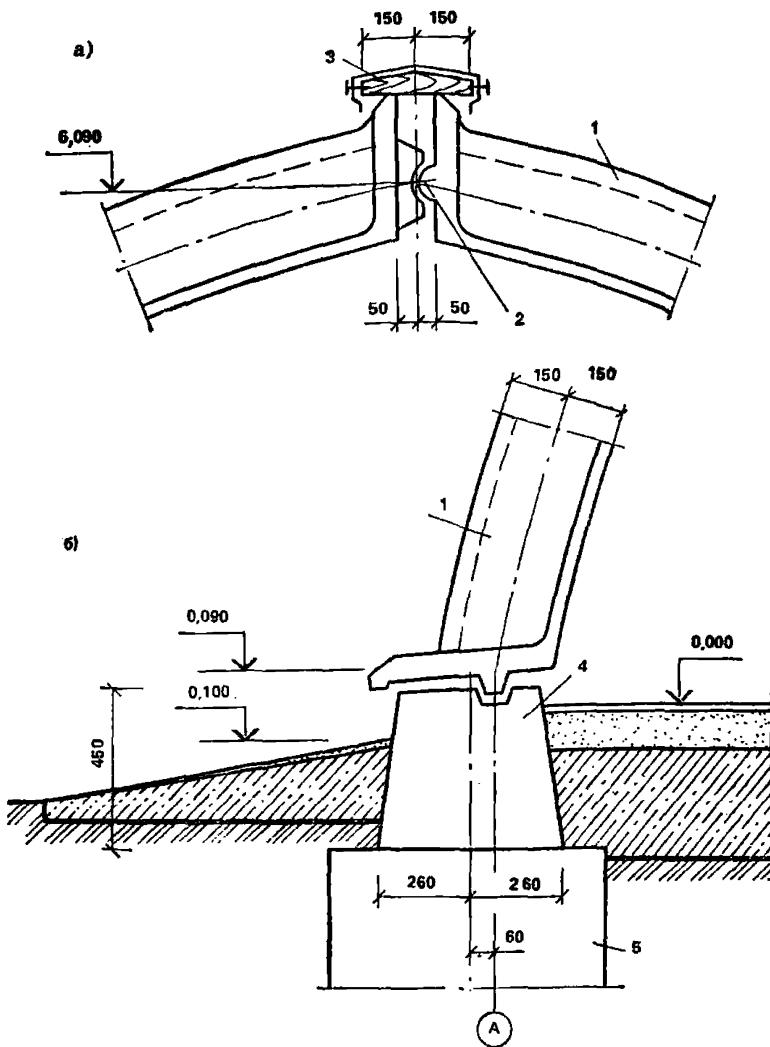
Опорные узлы сводчатых зданий из армоцементных элементов
